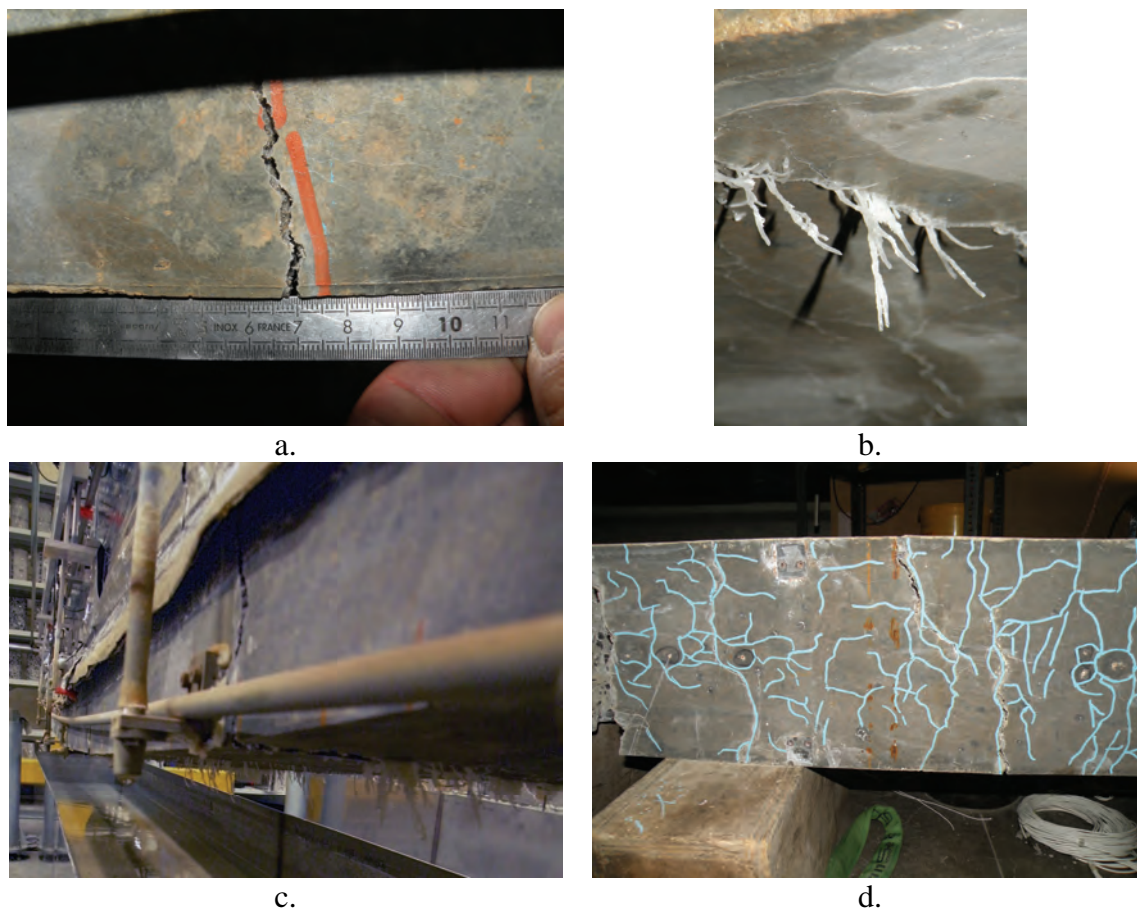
fissuration de la poutre P5 (partie 2)
